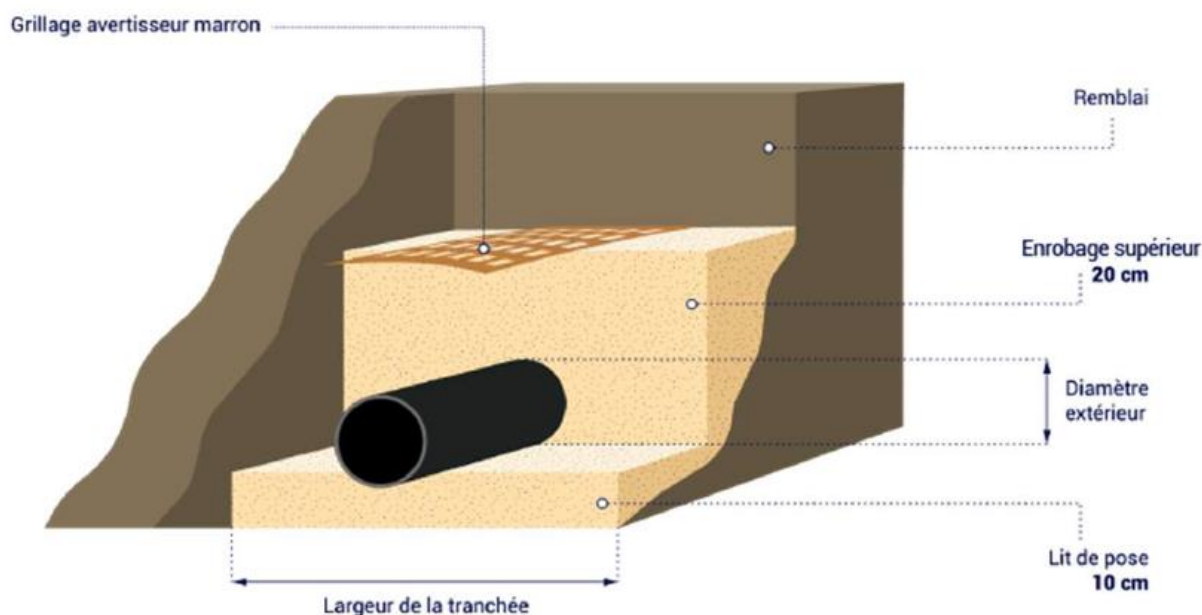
Coupe de principe d'une canalisation PVC enterrée
